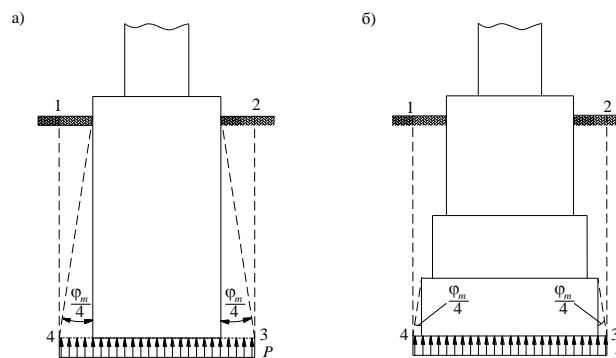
Условный свайный фундамент с ростерком, расположенным над грунтом, при угле наклона свай более $\varphi_m/4$
